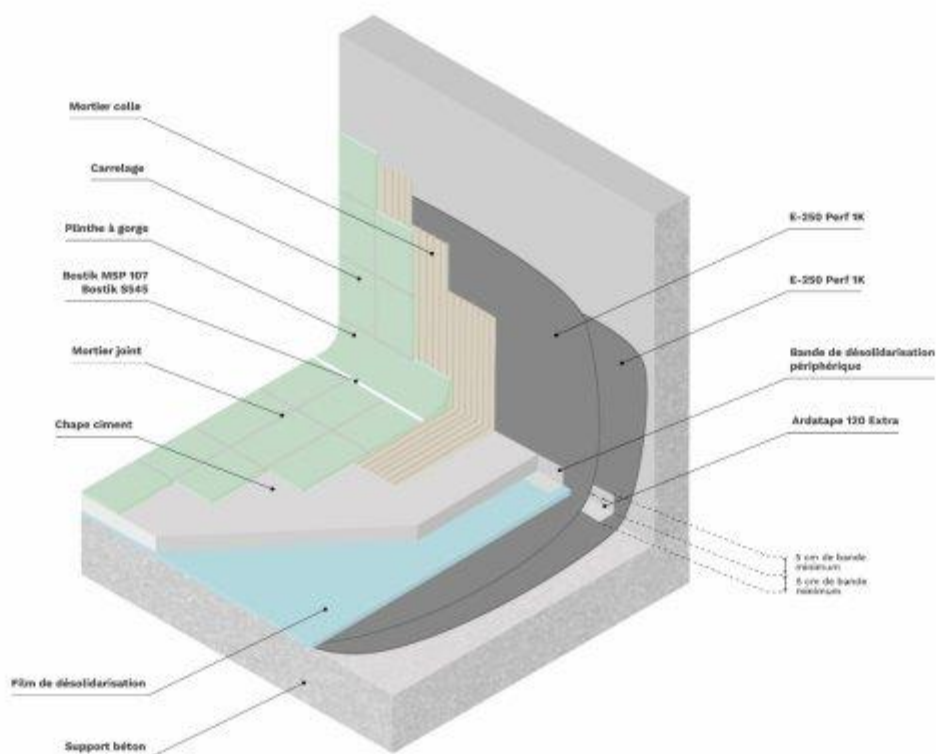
Raccordement Sol / Mur en local P4/P4S – cas de la chape rapportée sur E-250 PERF 1K
